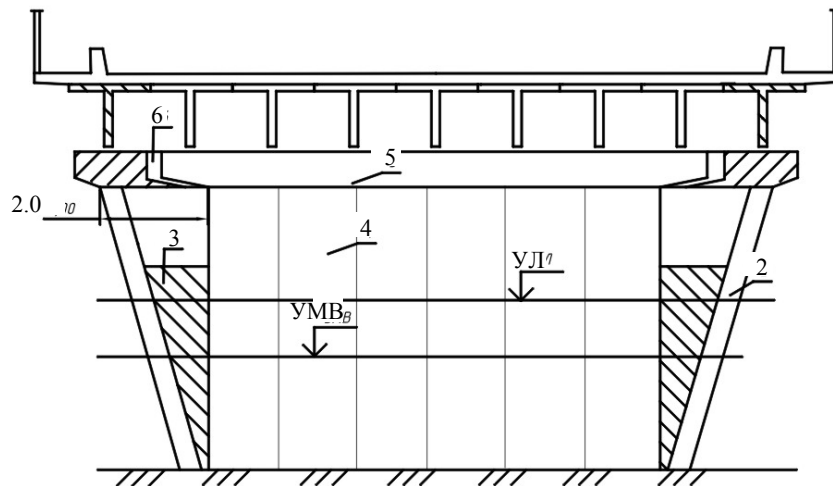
Уширение опор-стенок: а) – уширение сплошным массивом железобетона; б) – уширение с опиранием насадки на подкосы; У.Л. – уровень высокого ледохода; 1 – уширение массивом железобетона; 2 – уширение с опиранием на подкосы; 3 – массив бетона от ледохода; 4 – сборные блоки опоры; 5 – насадка; 6 – стык насадки
